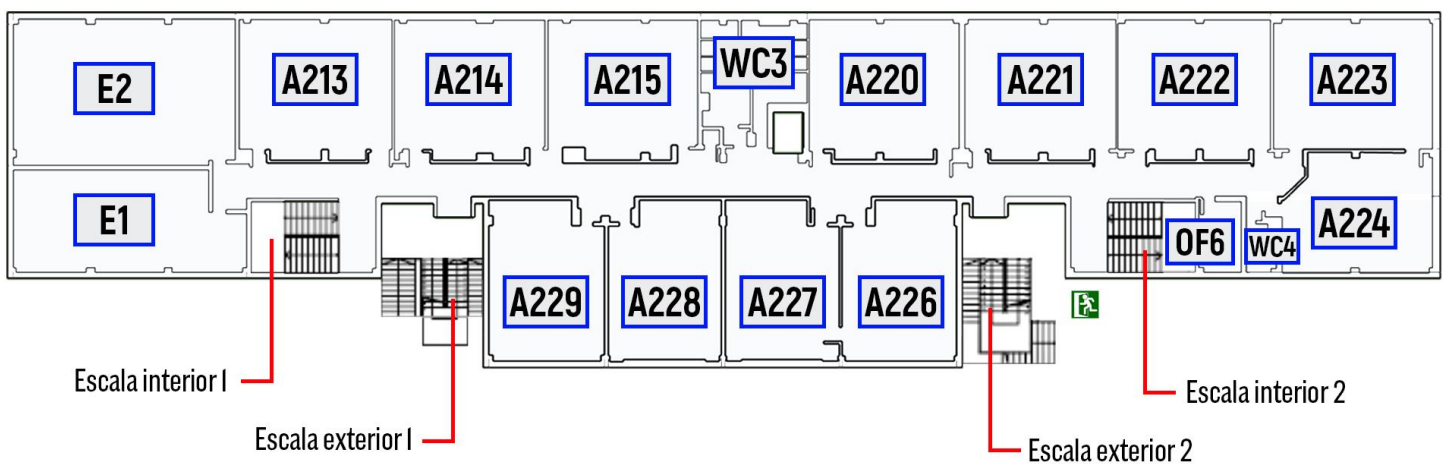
Visió en planta de la planta 1 amb els espais etiquetats.
